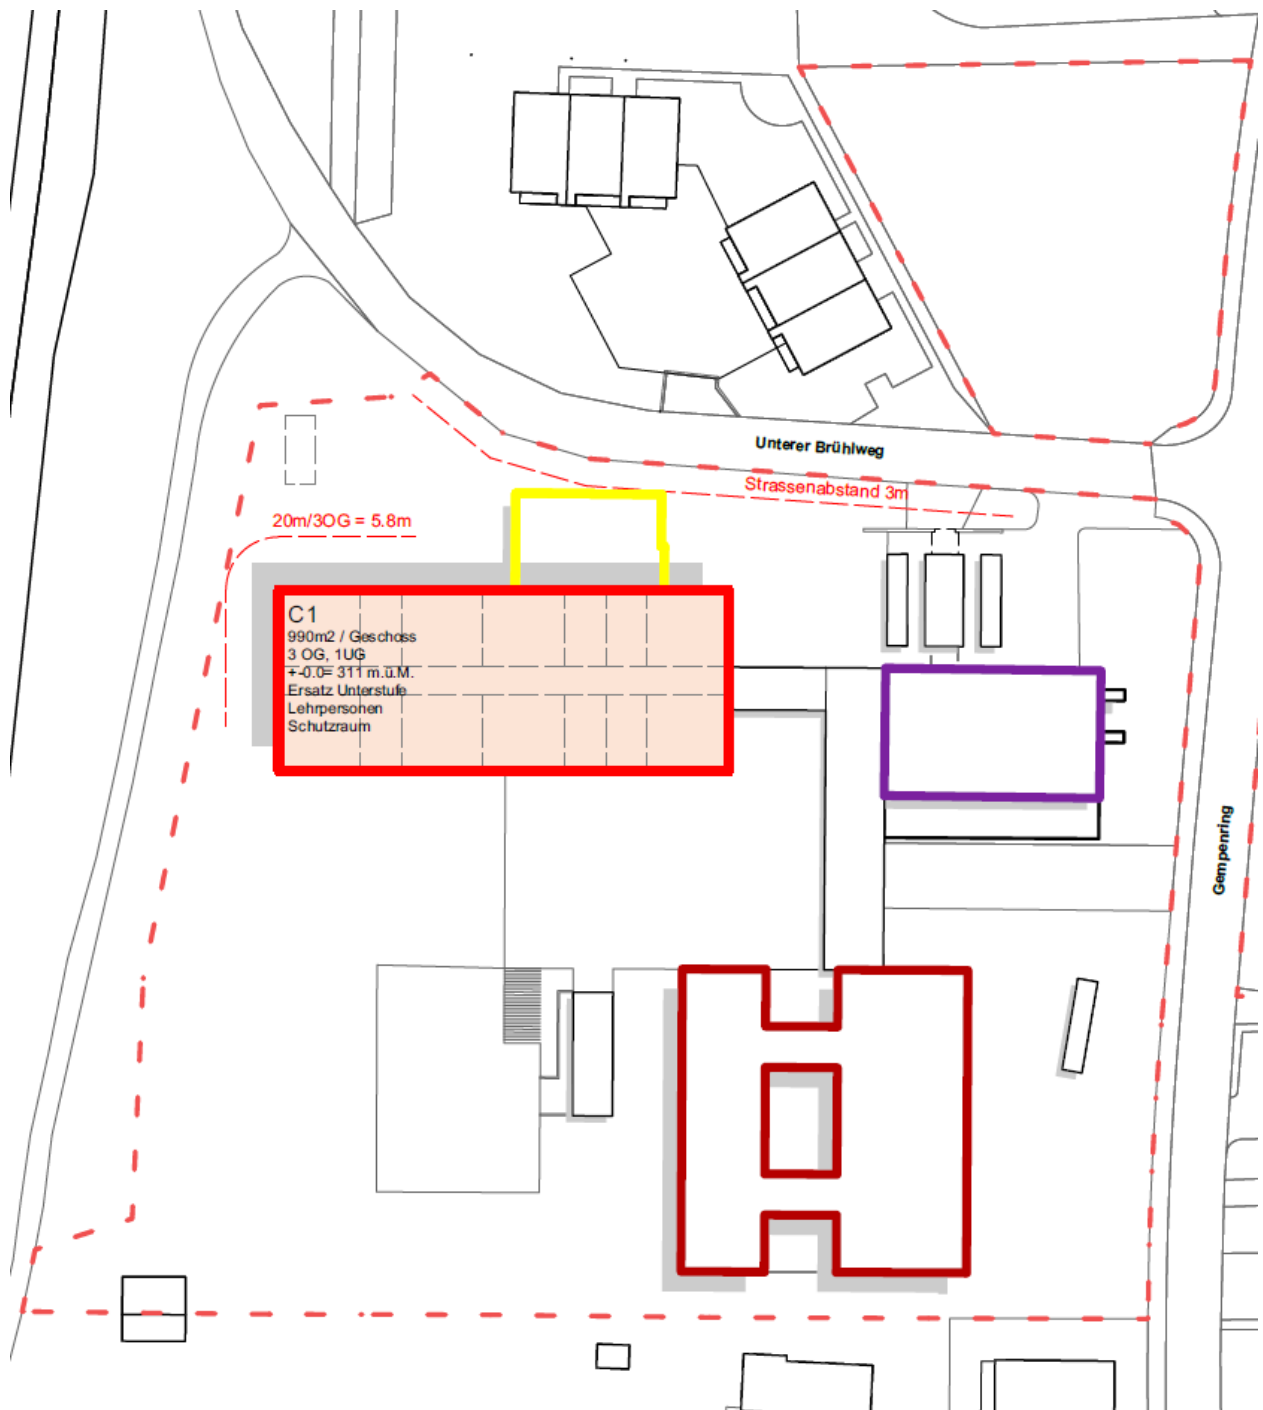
Etappe 1, Grundriss C.1
